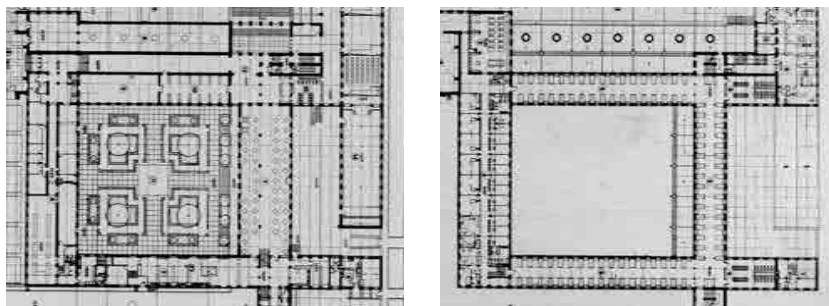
y Fig. 18 Pabellón de residencia de la Universidad Laboral de Zamora. Planta baja (izquierda) y planta primera (derecha).
